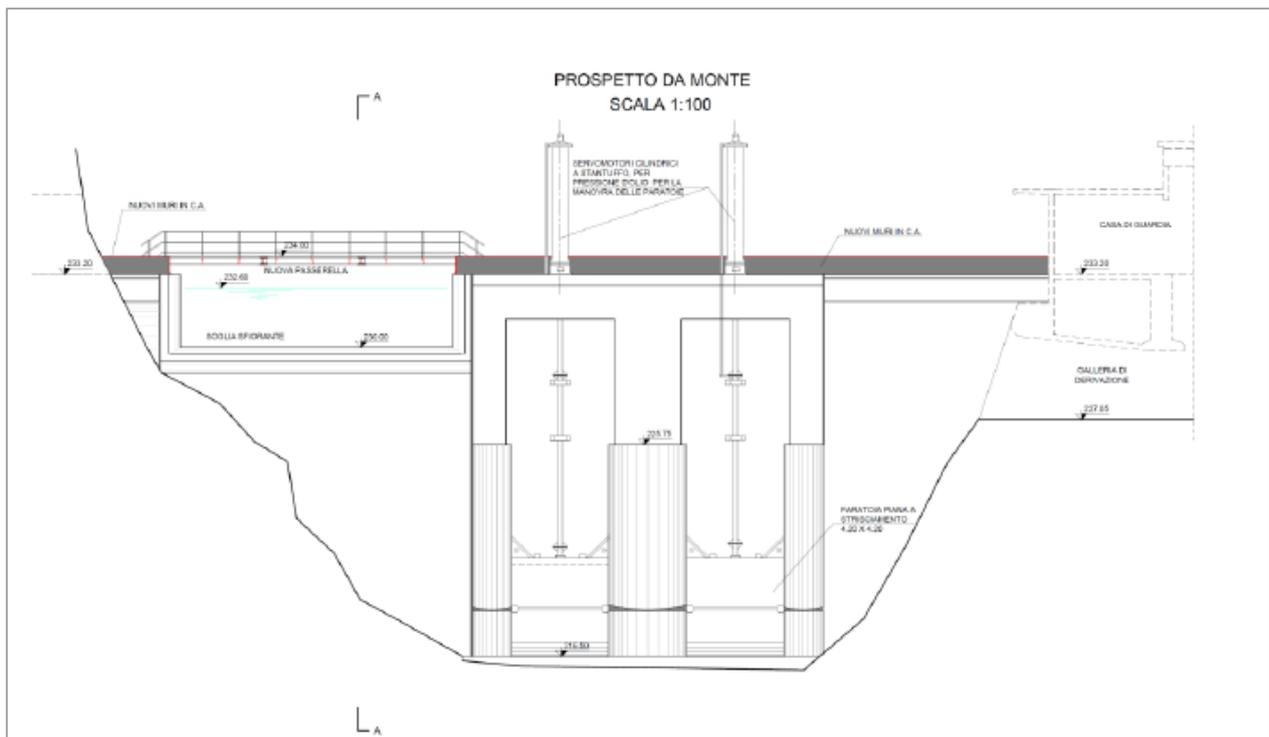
vista prospettica di progetto della diga con in evidenza il muro paraonda e la nuova passerella metallica sopraelevata rispetto alla quota di coronamento
